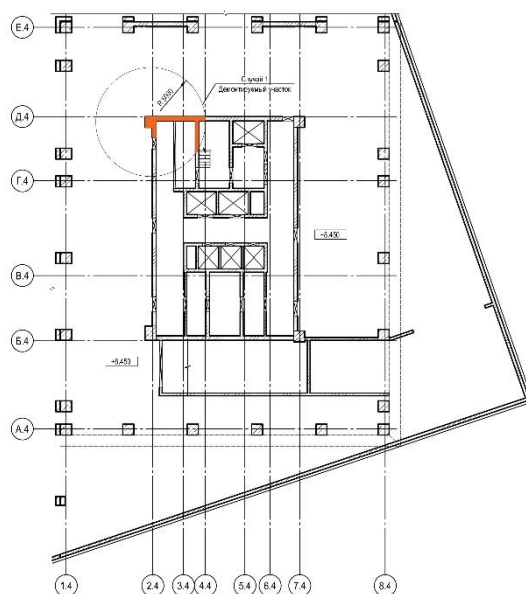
Корпус К-4. Схема аварийного случая 1
